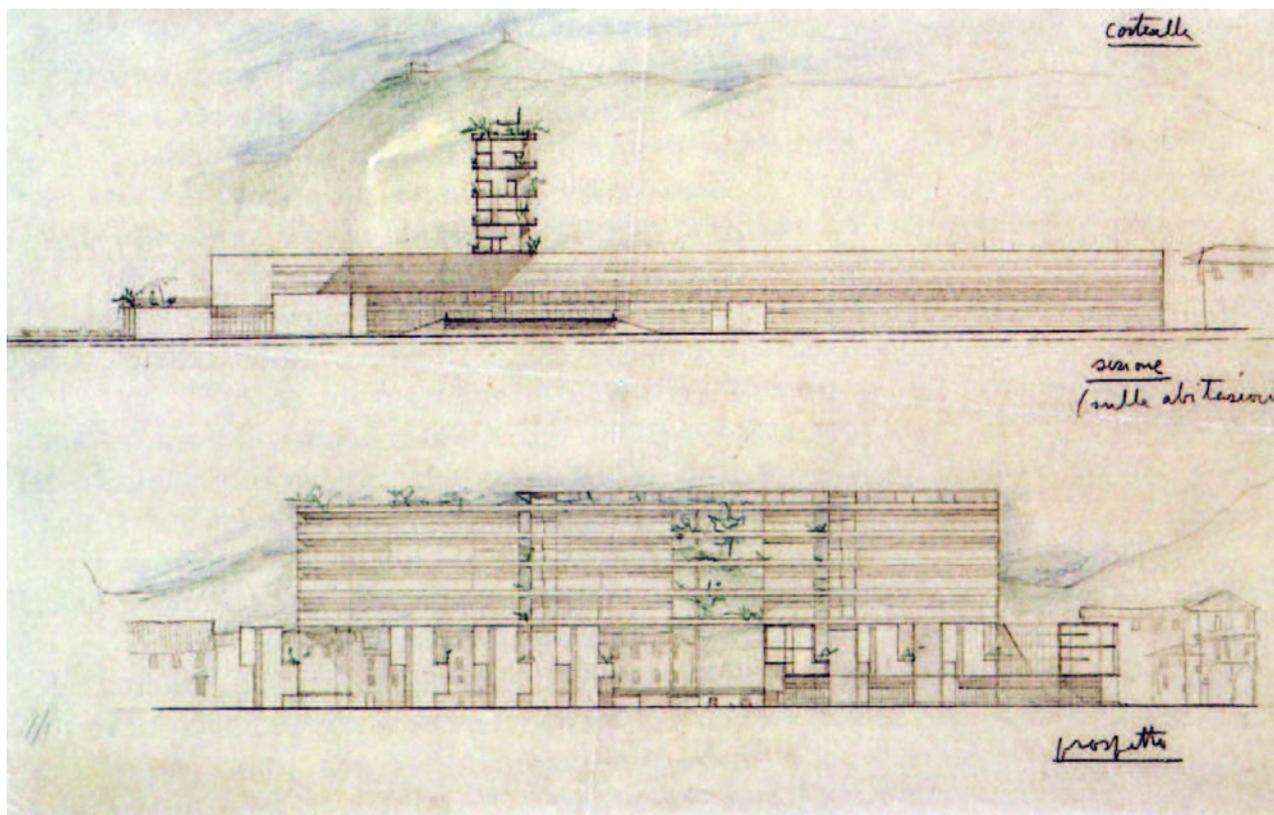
Giuseppe Terragni, Sezione e prospetto.
